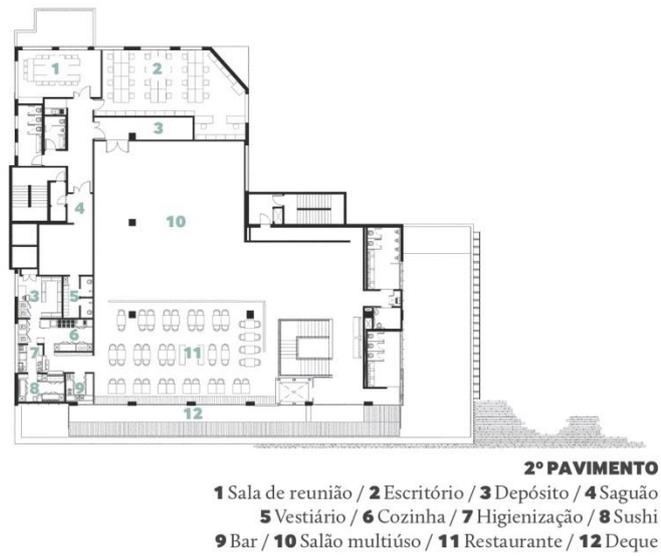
Planta Baixa segundo pavimento. <<https://www.arcoweb.com.br/projetodesign/arquitetura/ken-go-kuma-e-fgmf-arquitetos-japan-house-sp>> Acesso: 02/12/2019.
